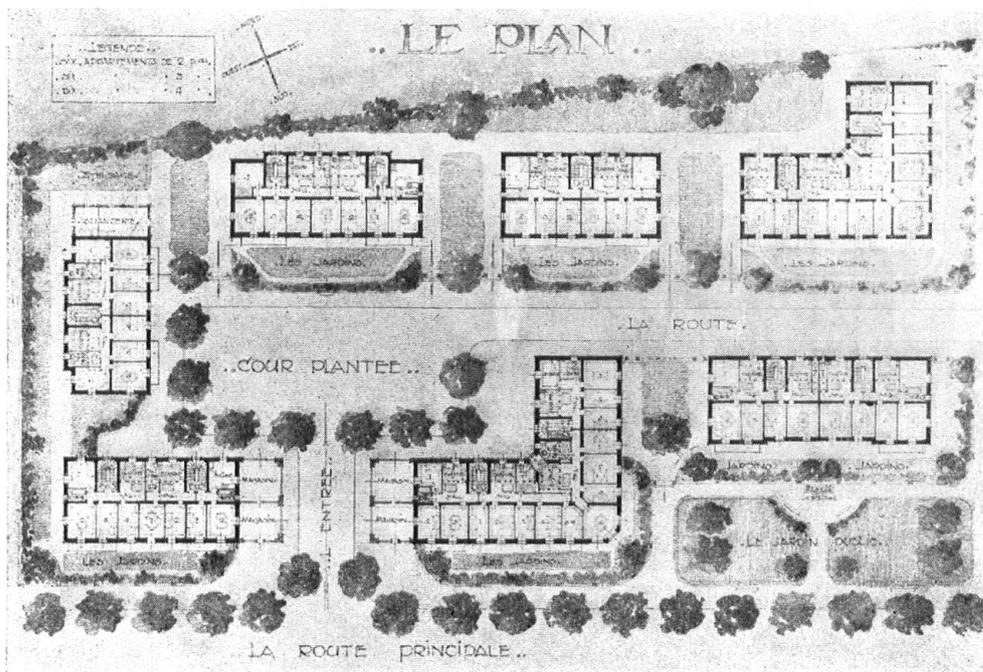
Projet „Site“. Plan. — Abb. 14. Entwurf „Site“. Plan.
